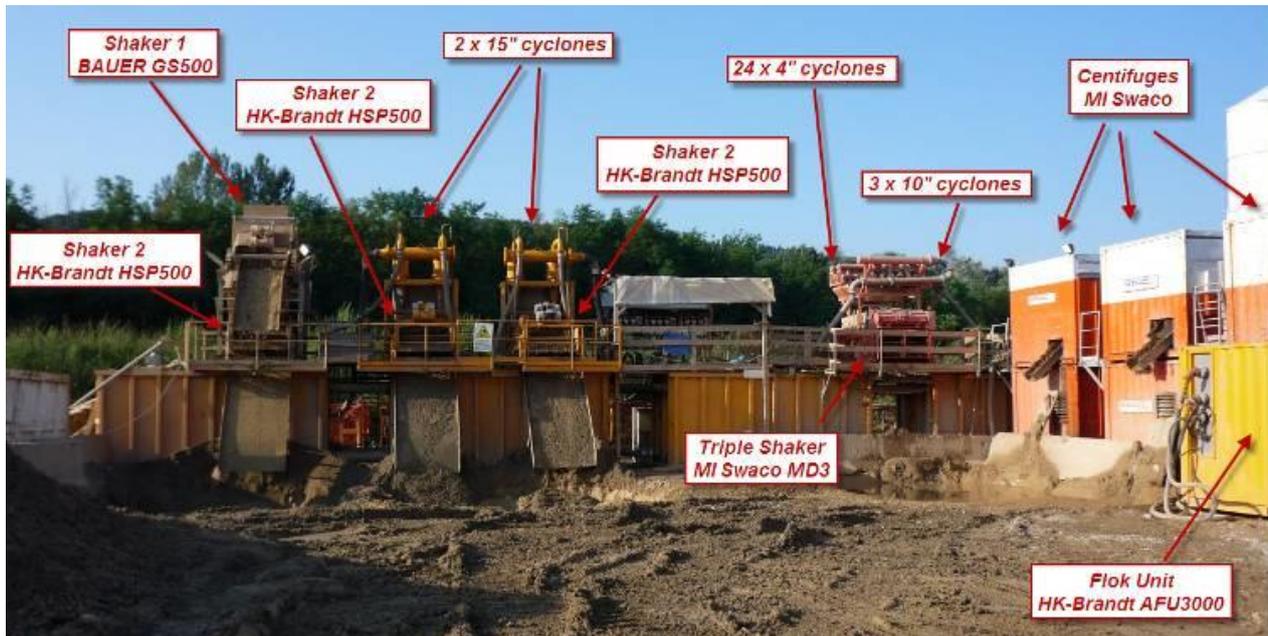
Installazione Tipica Dell'impianto di Separazione dello Smarino
